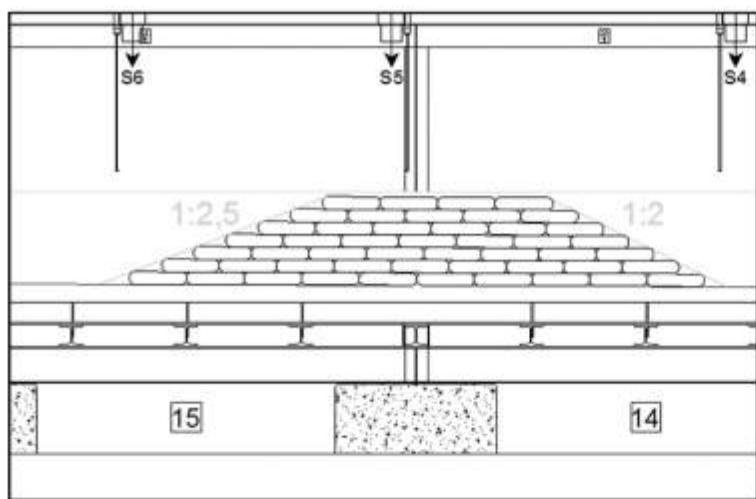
Prospetto longitudinale della configurazione con 7 file di sacchi (sommergenza pari a 3.2 cm) con profondità dell'acqua pari a 42 cm.
